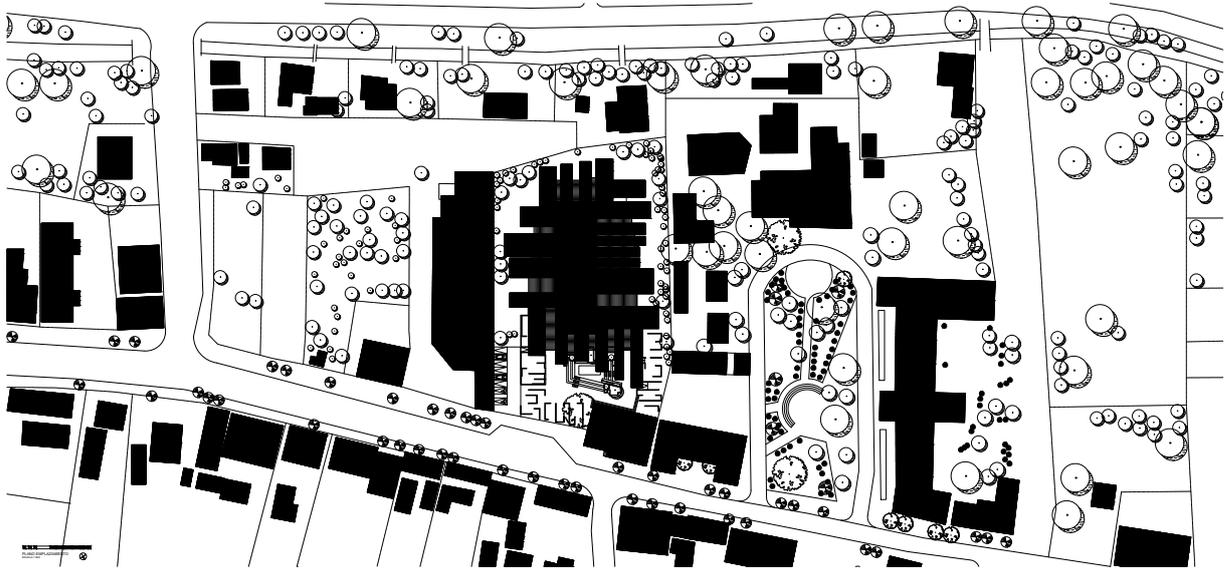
Planta cubierta avance de proyecto. (Elaboración propia)
